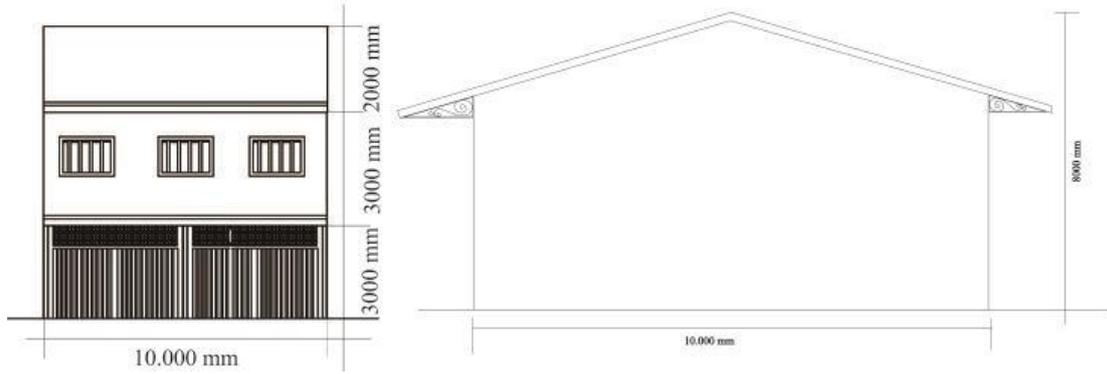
Proporsi bangunan 4 lantai di Pecinan
